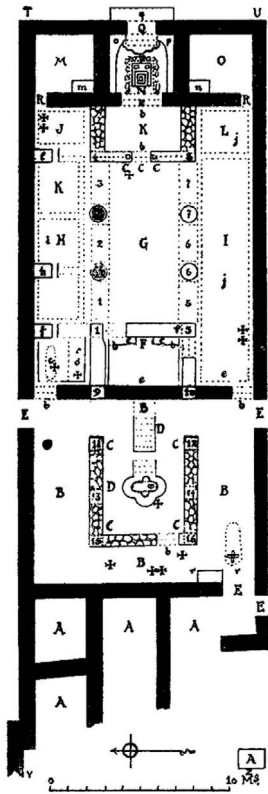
Planta de las edificaciones descubiertas por J. Aguiló (Aguiló 1920: 2)
